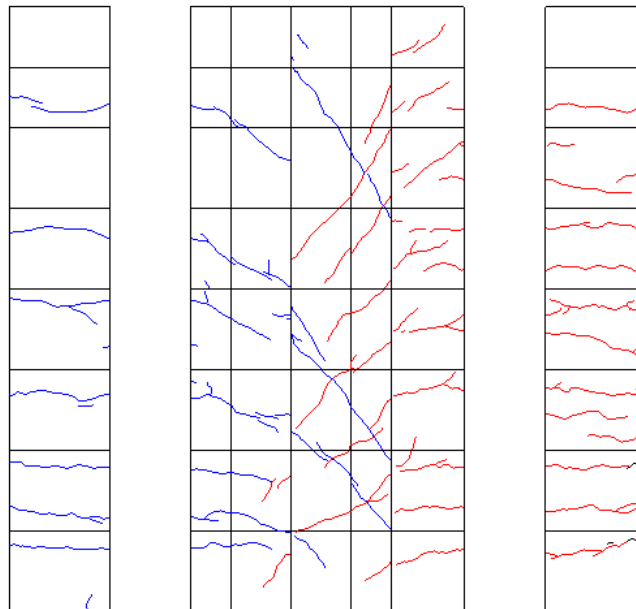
R=-1/200②ひび割れ図
